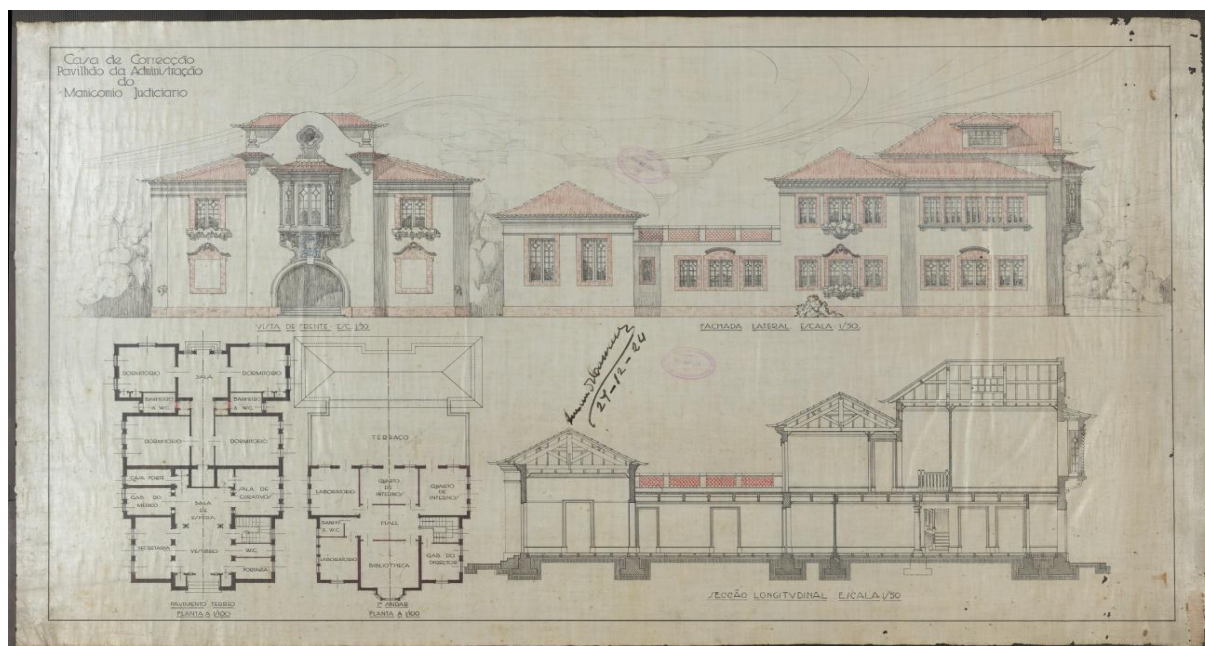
Planta de 1924, das fachadas e das divisões internas com o título: Casa de Correção – Pavilhão de Administração do Manicômio Judiciário. (BRRJ ANRIO 4T 0 MAP, 0244)
